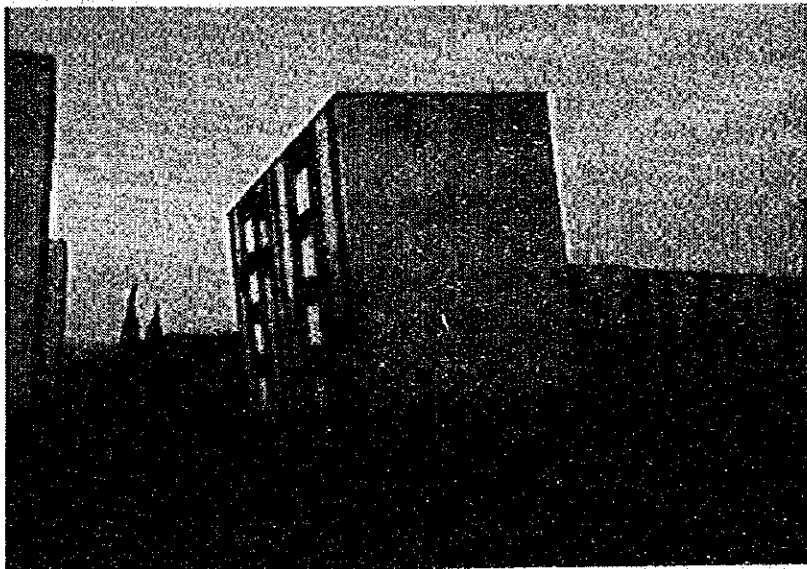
Beaucoup d'immeubles d'appartements ont aussi un niveau d'établissement. On voit des immeubles à la partie supérieure intacte, mais inclinés à cause de la rupture des piliers courts.
